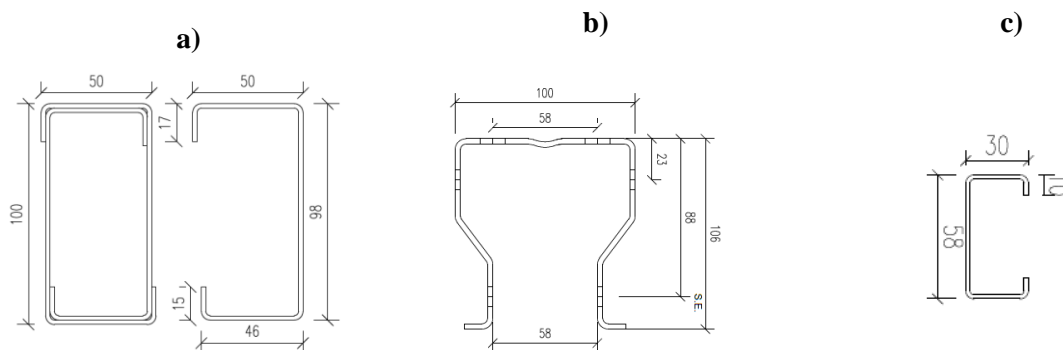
Detalle de perfiles cold formed. a) VIGA 100/50/2.0 mm, b) PILAR 100/106/3.0 mm, c) RIOSTRA 58/30/2.0 mm
